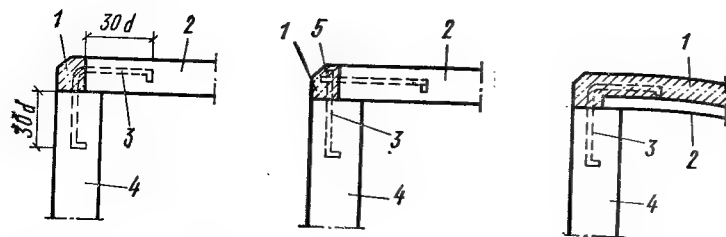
Узлы сопряжения покрытия со стенами из бетонных блоков (кирпичной кладки)
